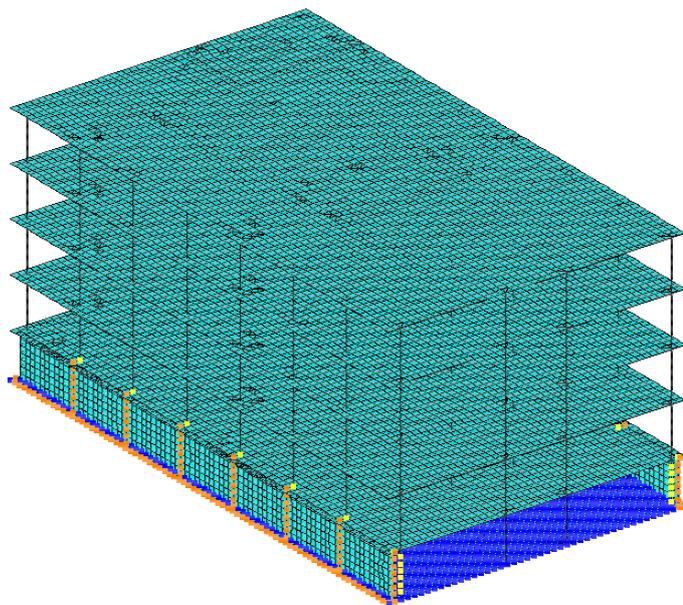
Расчетная схема здания в ПК Лира
